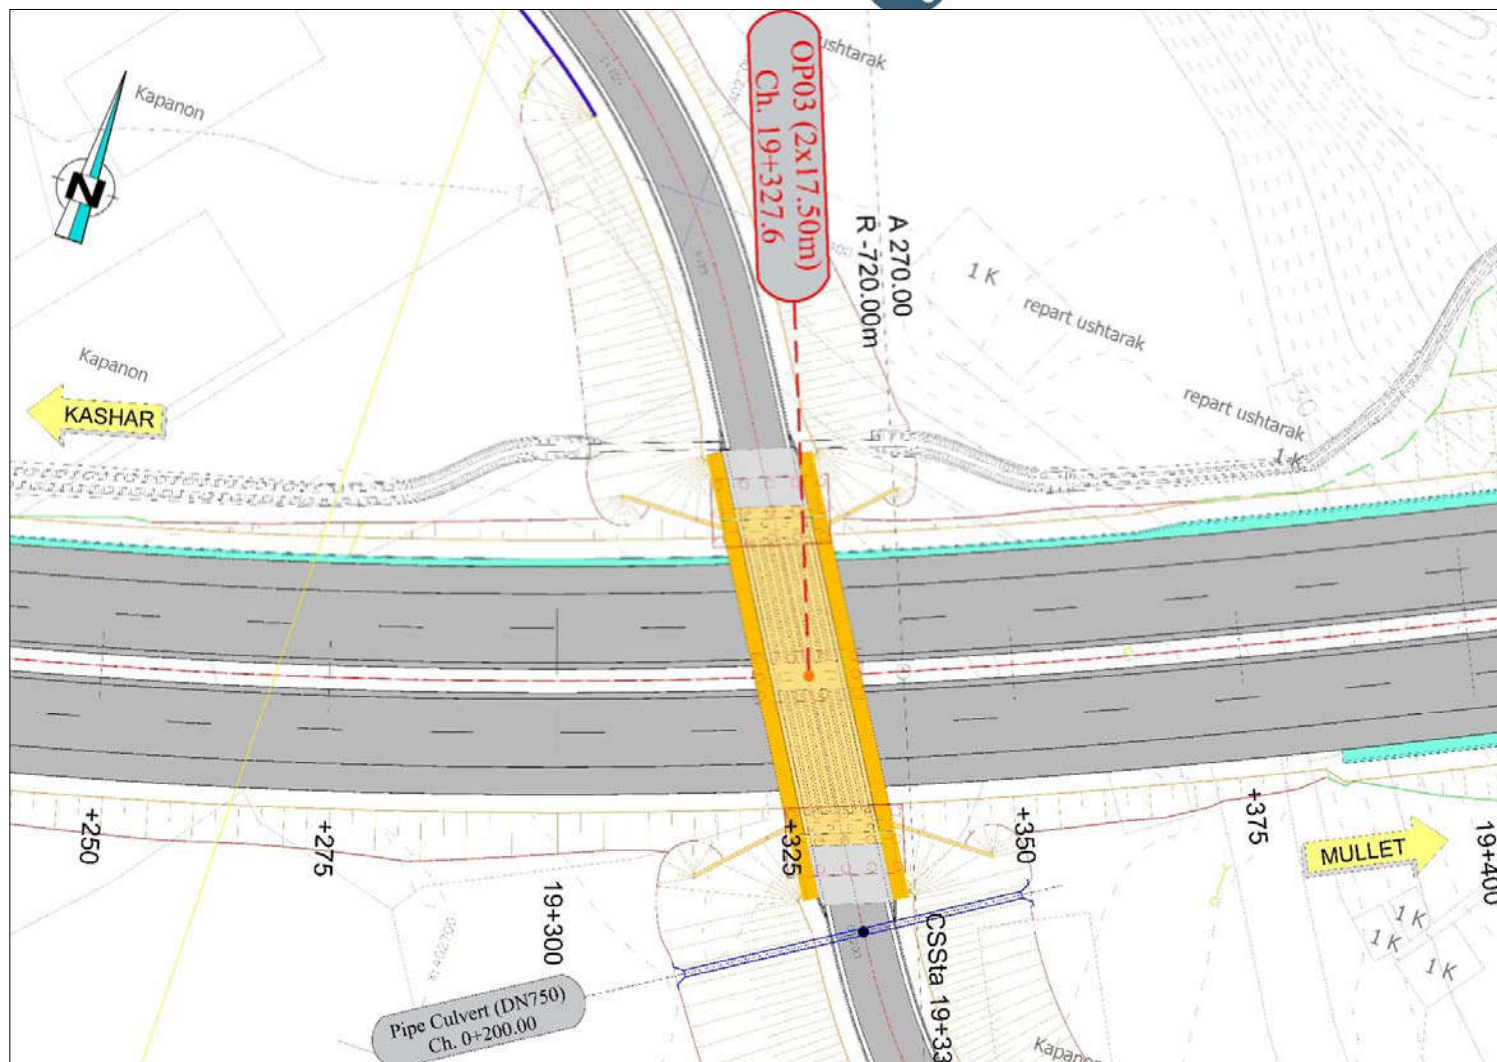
Pamje planimetrike e Mbikalimit 03, L=33.4m (Hapësira 2x16.7m)
